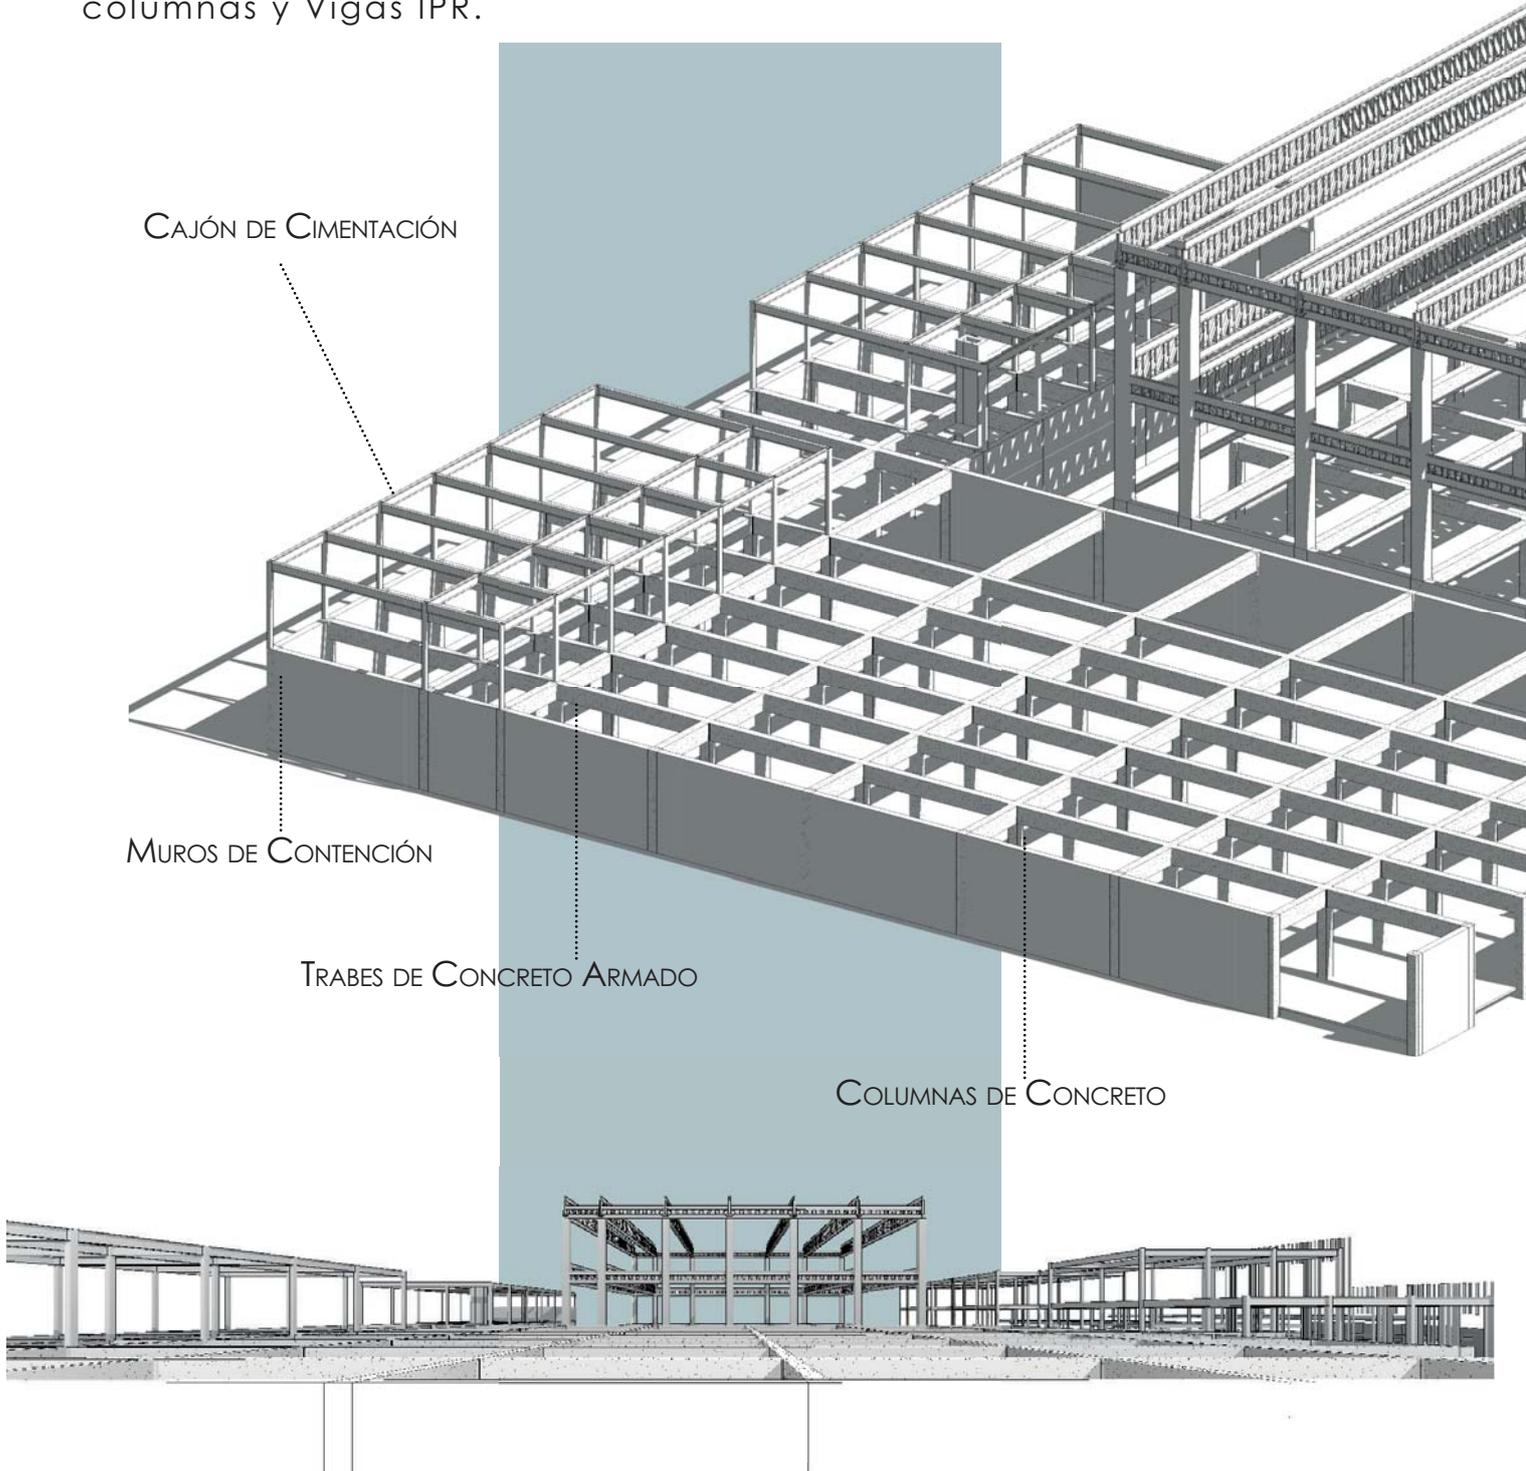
PERSPECTIVA ESTRUCTURAL. AUDITORIO PRINCIPAL.
